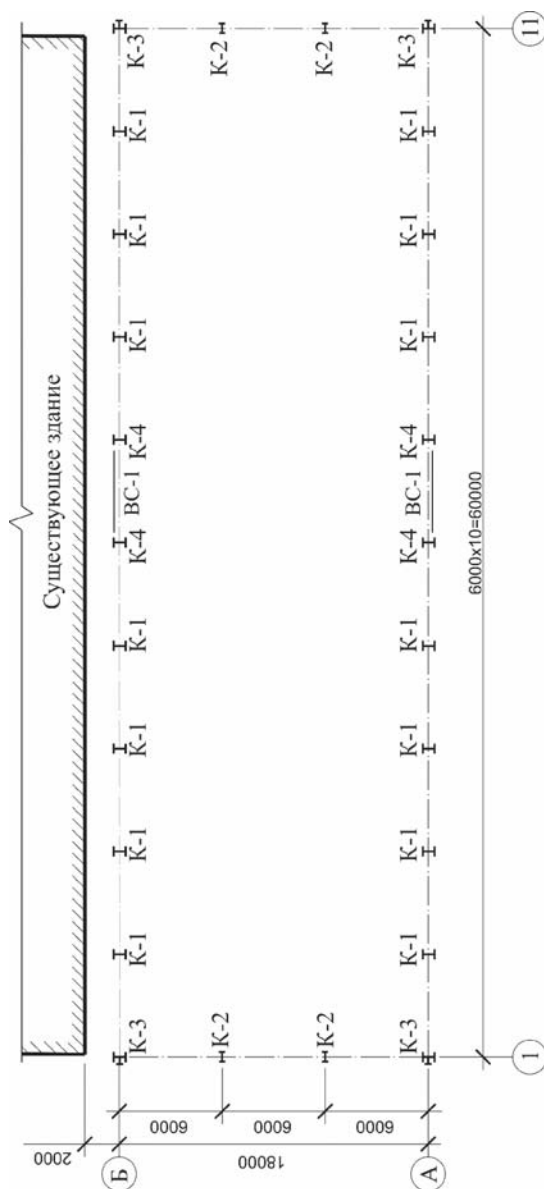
План колонн (покрытие с фермами пролетом 18 м)
